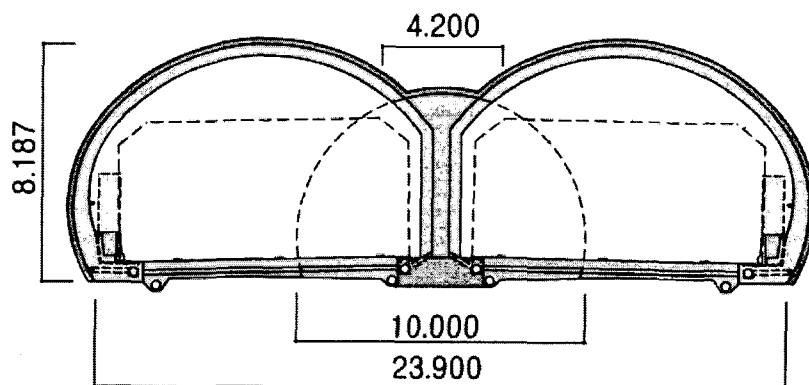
원형터널 (prototype tunnel)의 단면도 (단위: m)
